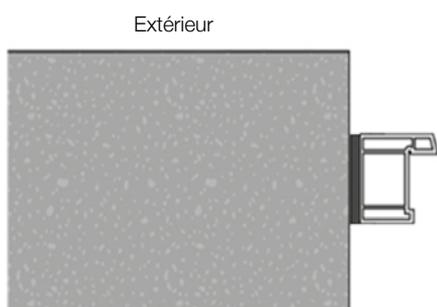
Principe de pose de mousse imprégnée, sur menuiserie en pose tunnel (exemple de bandes sur toute la largeur du dormant)
